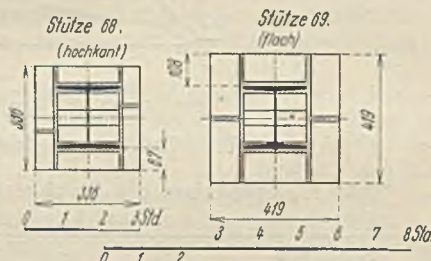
Stützen-Ummantelung mit Mauerziegeln.
